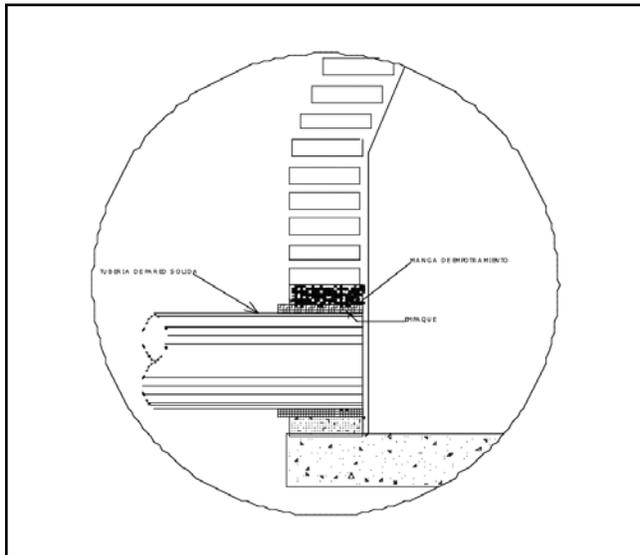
Conexión con estructura de la tubería de PEAD estructura y de pared solida
